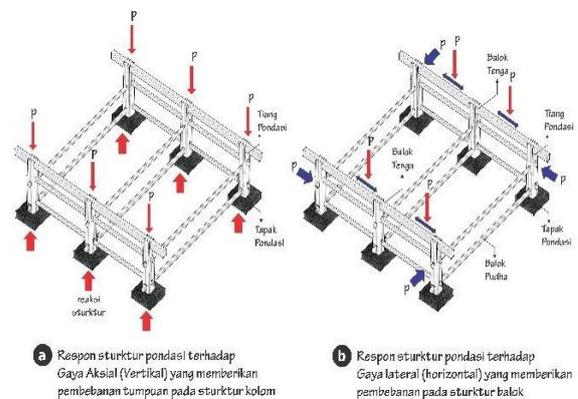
Tahapan Konstruksi Struktur Pondasi, 2019
